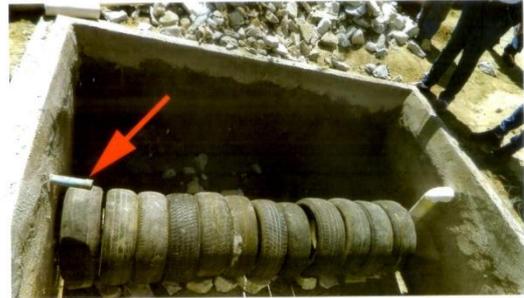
Tubo ladrão (tubo do lado esquerdo)
